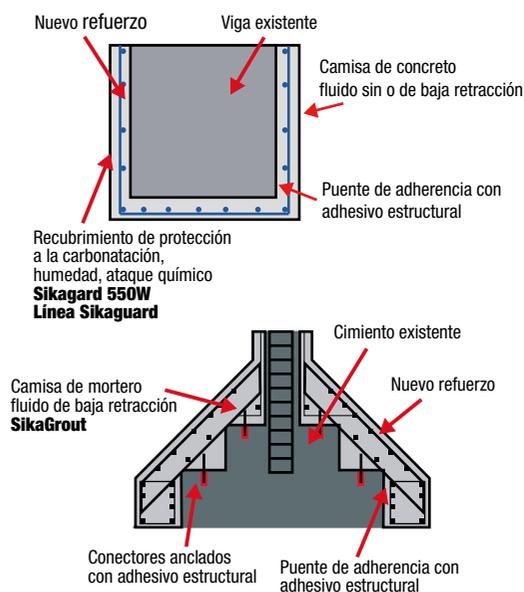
Encamisado en concreto reforzado de una viga y de cimentación
